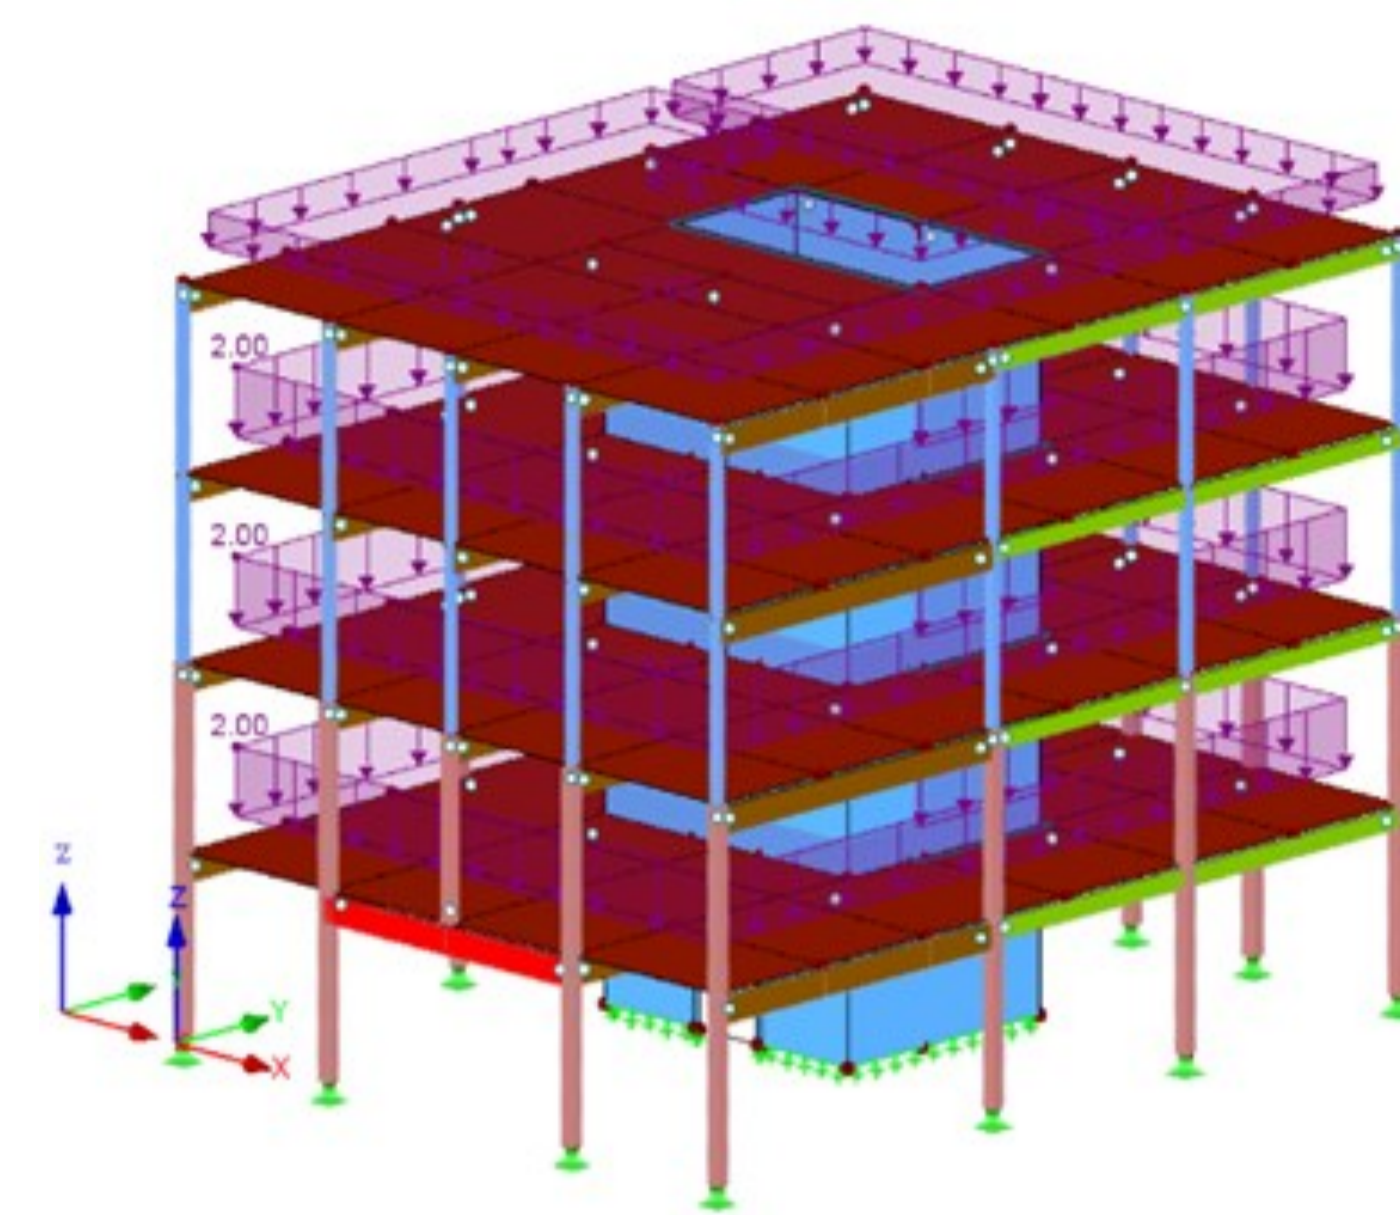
Análisis estructural de cargas residenciales según el CTE (Código Técnico de la Edificación) en un edificio de varias plantas en Linares, Jaén. Estructura principal: vigas y pilares prefabricados GL24h.
